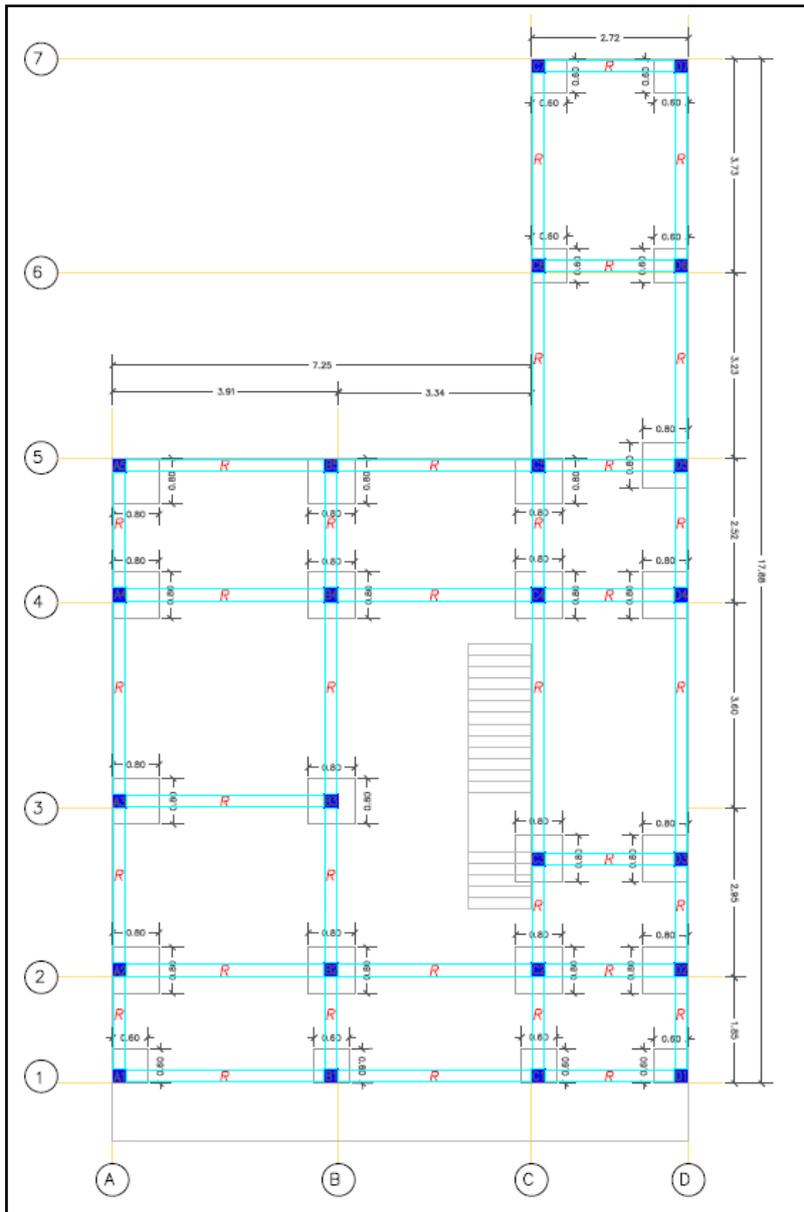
10 Extracto de Planos Estructurales reconstruidos (Rivera J., 2024)
